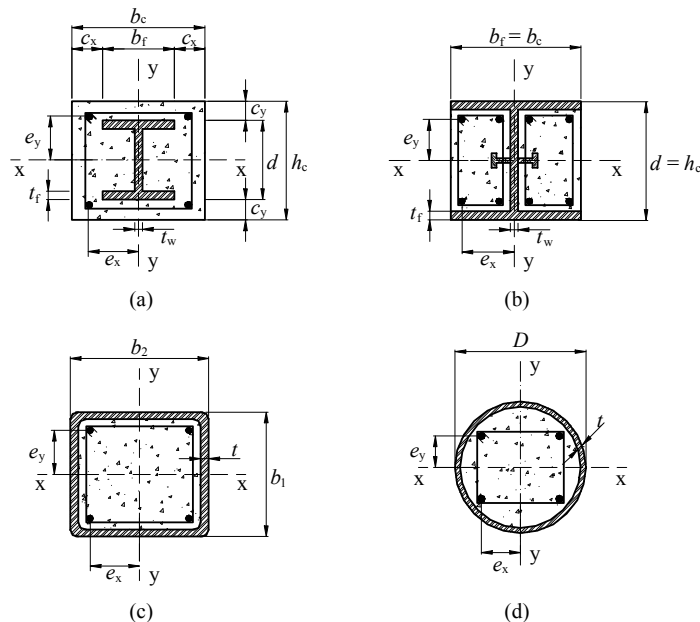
Tipos de seções transversais de pilares mistos (ABNT NBR 8800:2008).
